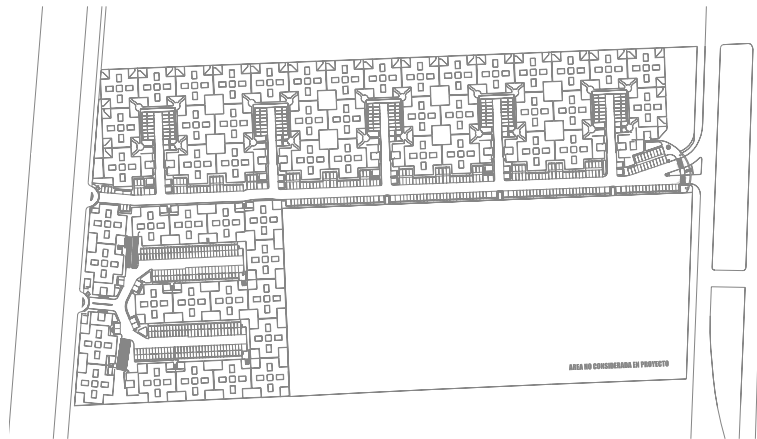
Croquis de Distribución Proyecto Arcos de Aragón
